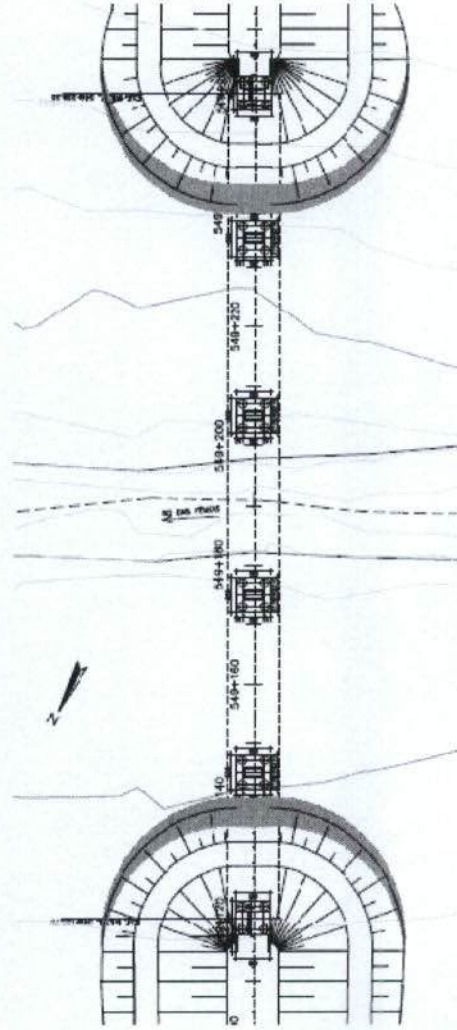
Projeto da ponte sobre o Rio das Fêmeas II (planta de situação)
